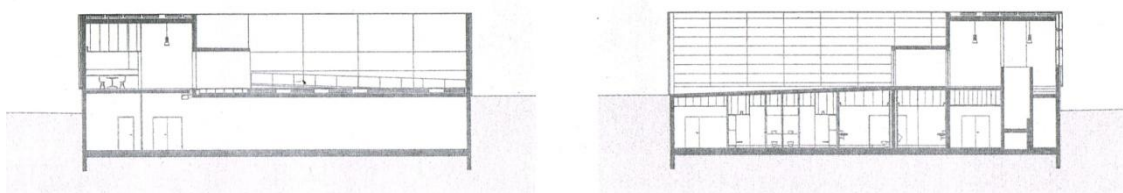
Operação de Coordenação de Centro Brisa, 2002, em Carcavelos, Portugal, por João Luís Carrilho da Graça e Flavio Barbini, Maria João Silva Barbini, cortes transversal.
